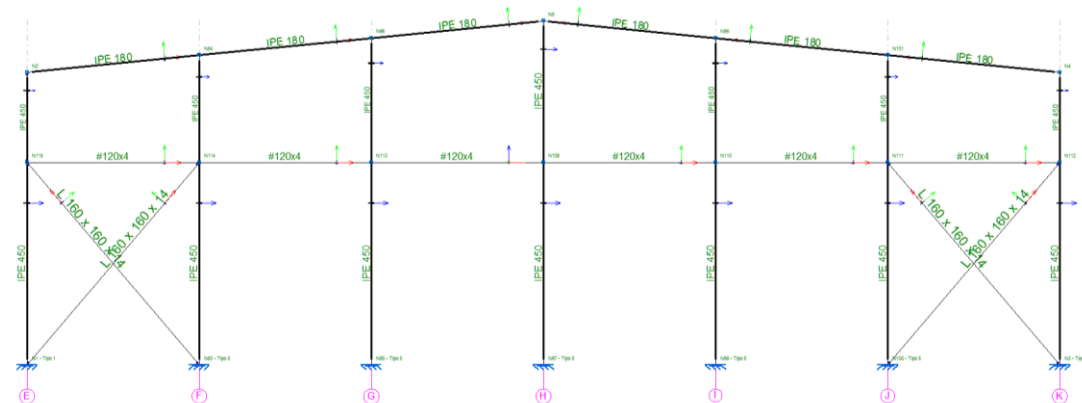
Pórtico de fachada con detalle de perfiles
